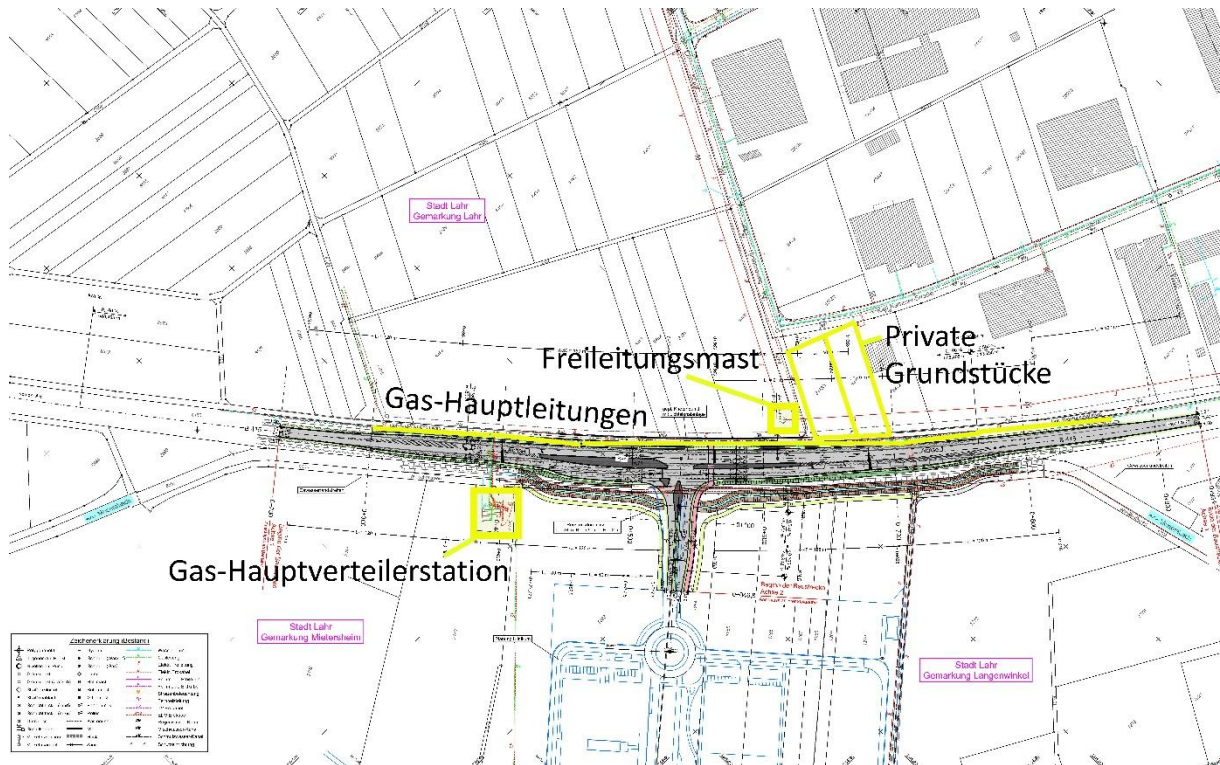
Plangleiche Lichtsignalanlage (3-armig) – Planerische Zwangspunkte (gelb)
